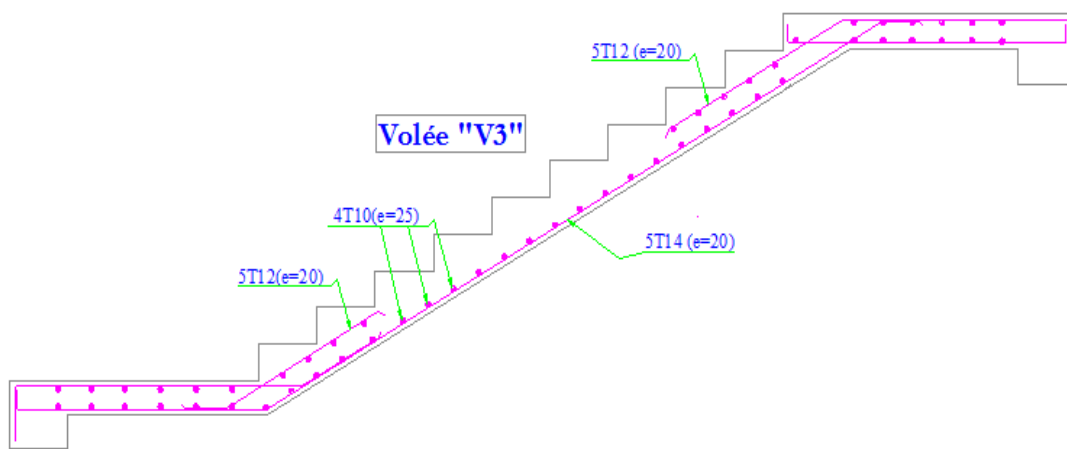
Ferrailage de la volée 3 d'escalier de RDC (type 1).
